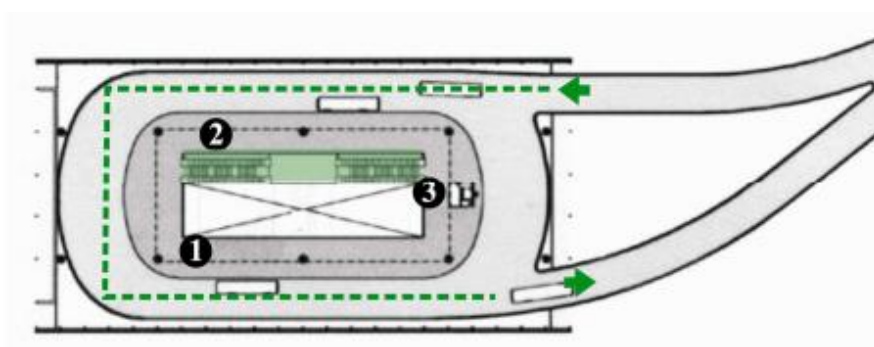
Terminal Sacomã- planta térreo. Fonte: FALCÃO, 2009
